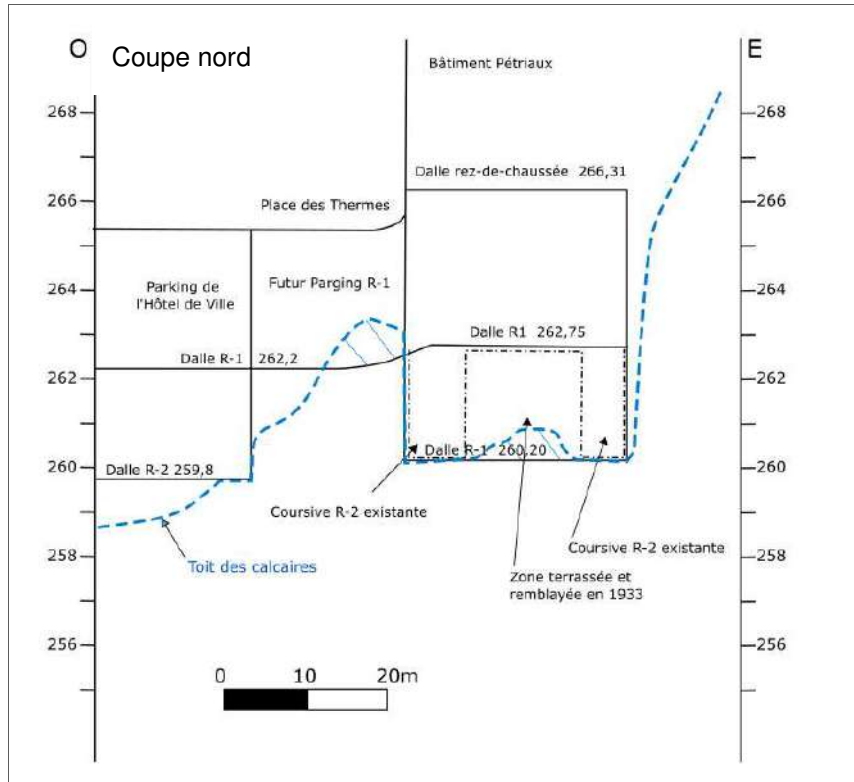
Coupes en travers des futurs parkings (en hachuré, les zones de terrassement des calcaires)
